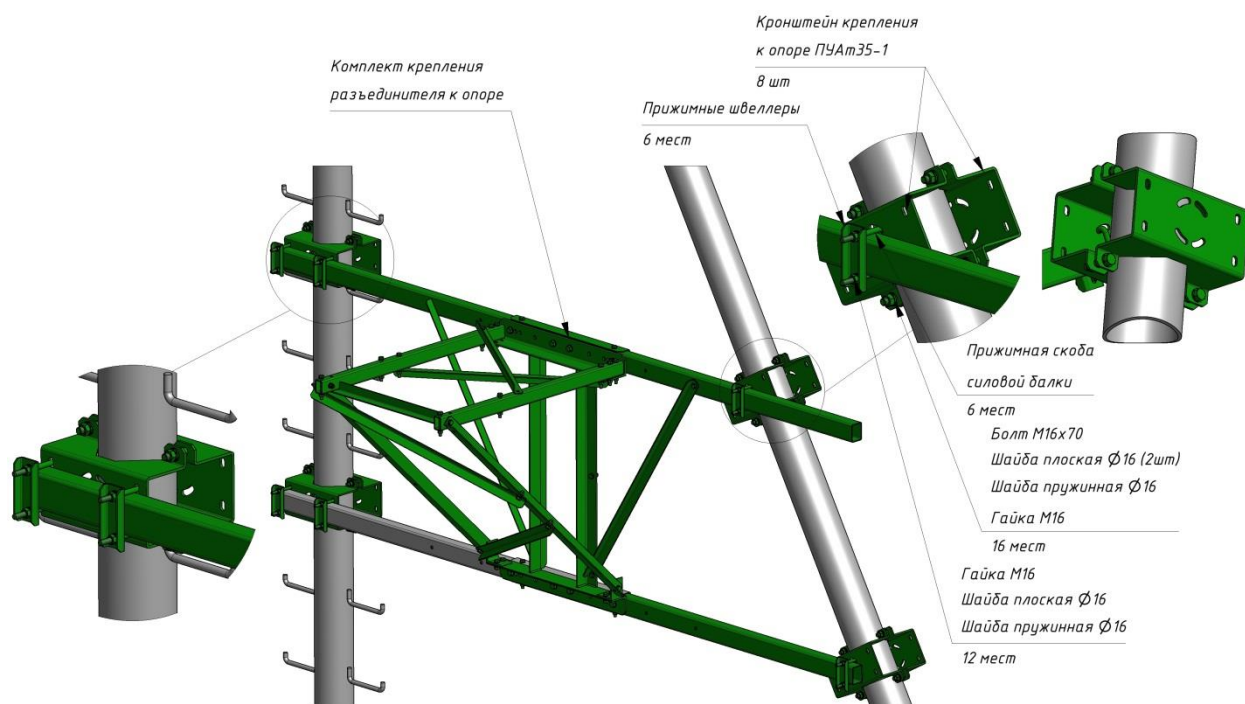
Установка кронштейна разъединителя на опору ПУАт35-1
